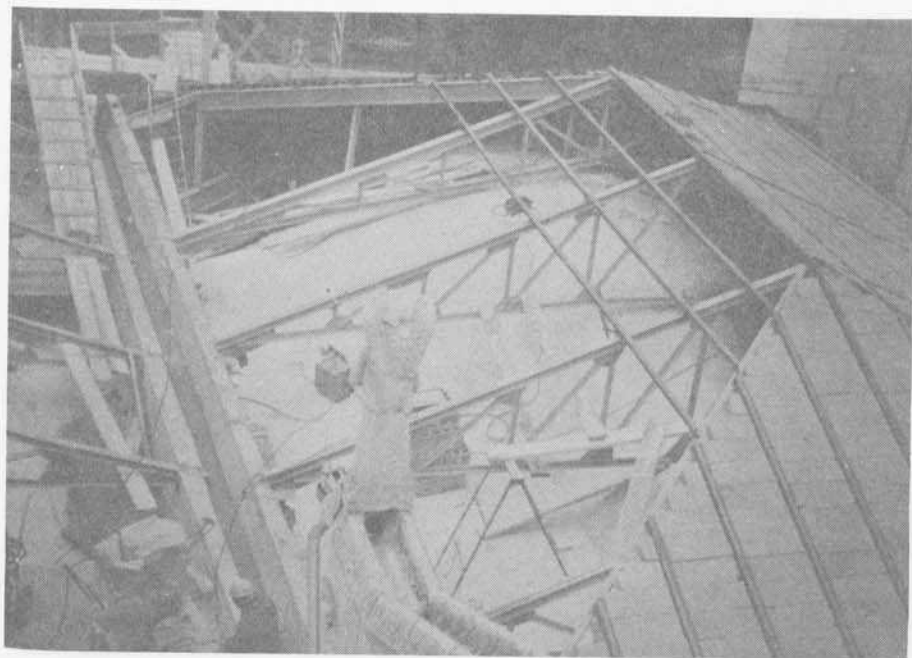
Estructura metálica final de la Capilla de Santa Ana
